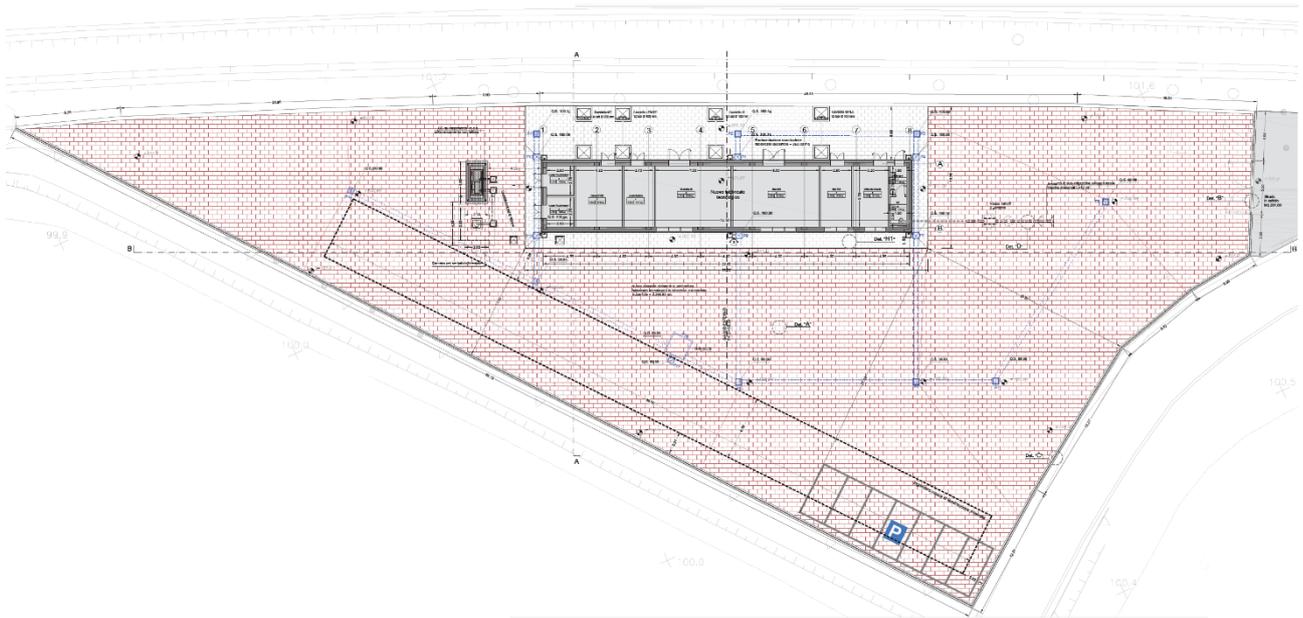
GA SUD Esterno -Planimetria di progetto
